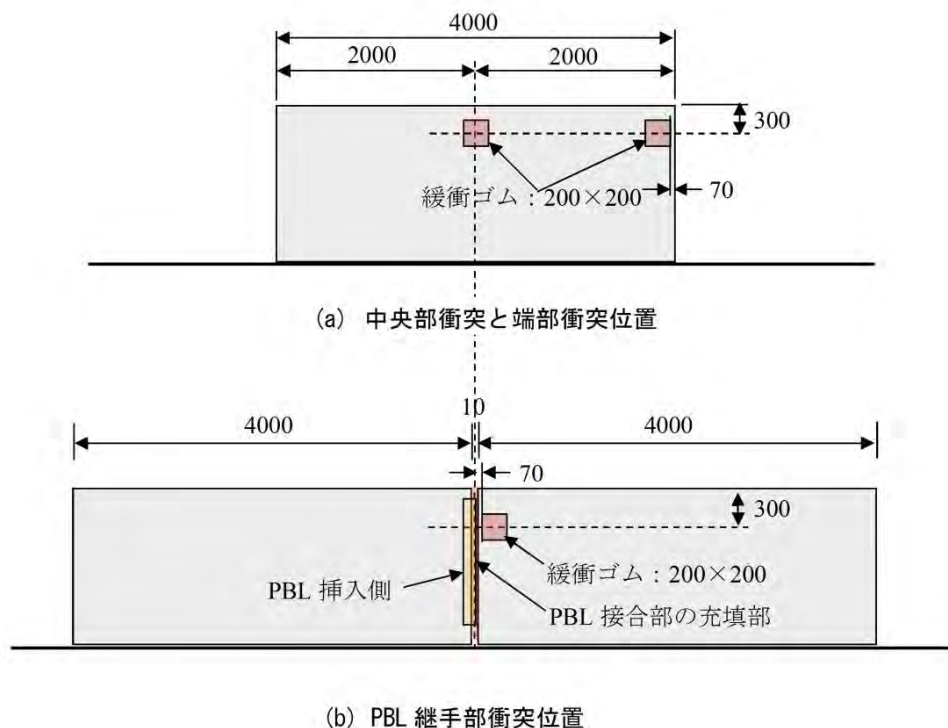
DAK 式壁高欄の衝突荷重の衝突位置
